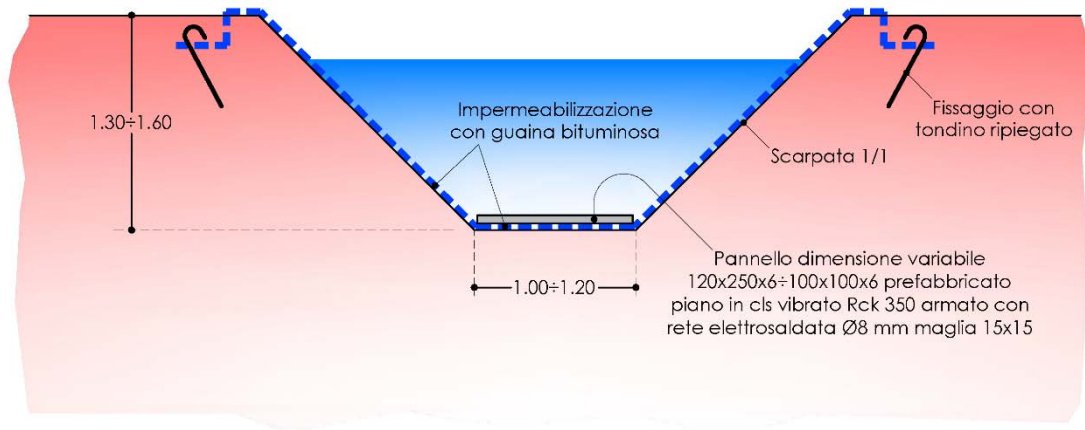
Adduttori. Impermeabilizzazione con guaina e piastra in c.a..
